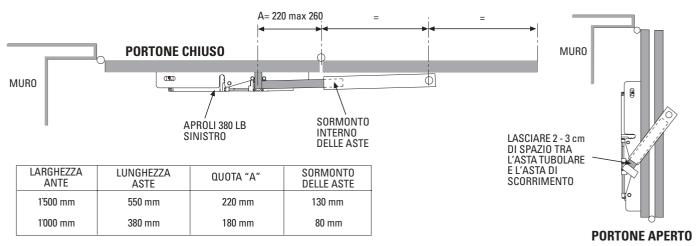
APROLI 380 LB INSTALLATO SULLA 1° ANTA CON ATTACCO DELL'ASTA SULLA 2° ANTA
